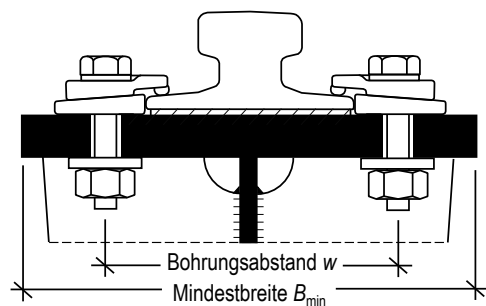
Beispiel einer durchgeschraubten Befestigung der Schiene mit Klemmplatten und elastischer Unterlage
